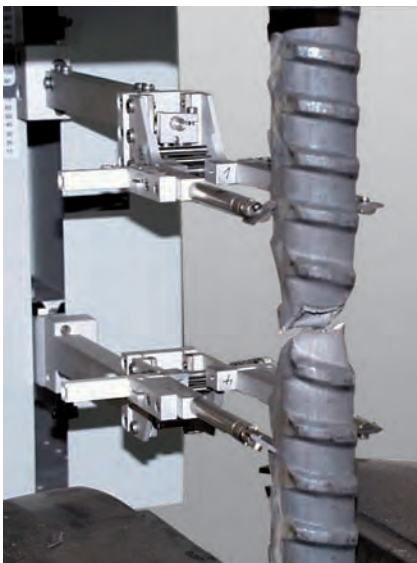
Zugversuch an Betonrippenstahl mit Makro Längenänderungsaufnehmer
